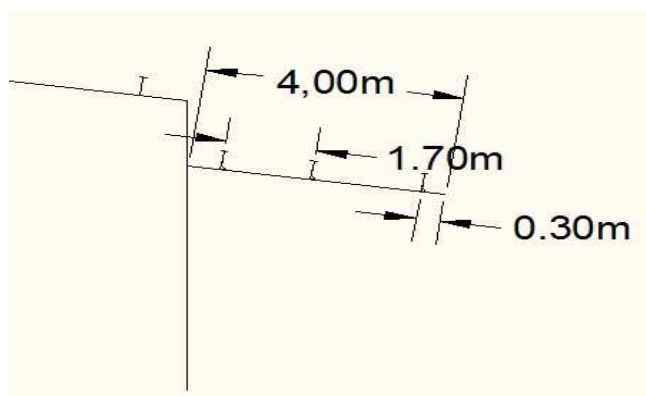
9: Illustration de la disposition des pannes sur l'avancement de toiture
